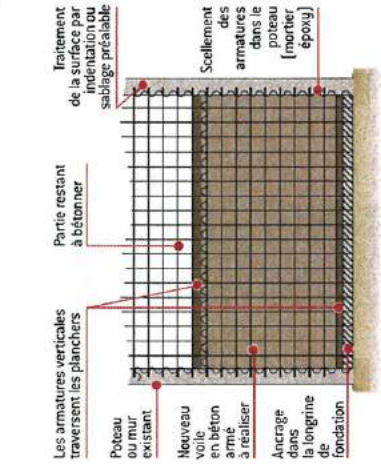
Exemple de renforcement du contreventement d'un bâtiment par création de murs nouveaux entre deux poteaux existants (élévation)
